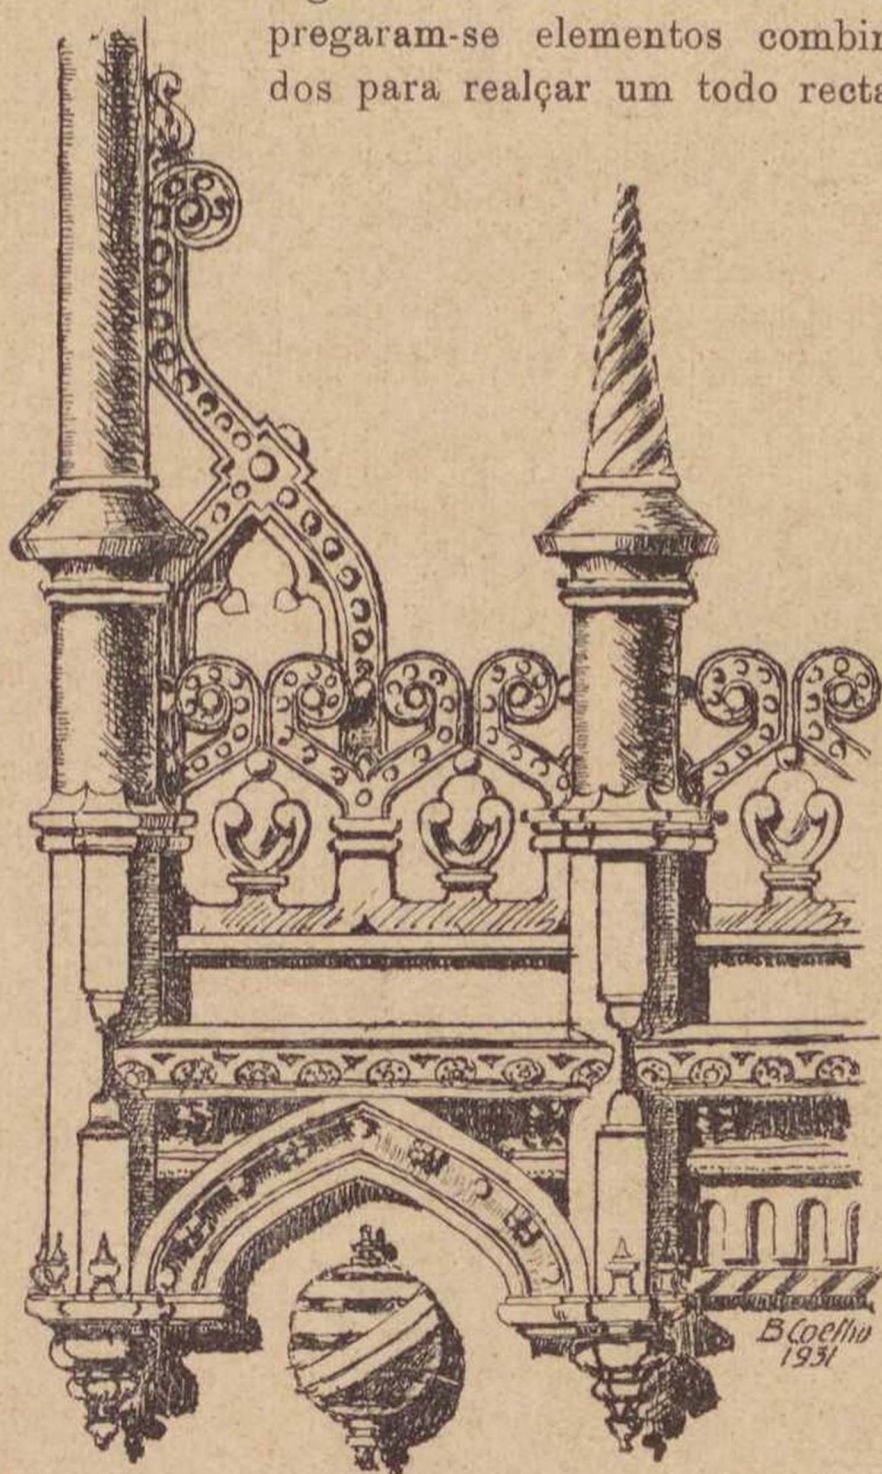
Pormenor da ligação da torre com a balaustrada
